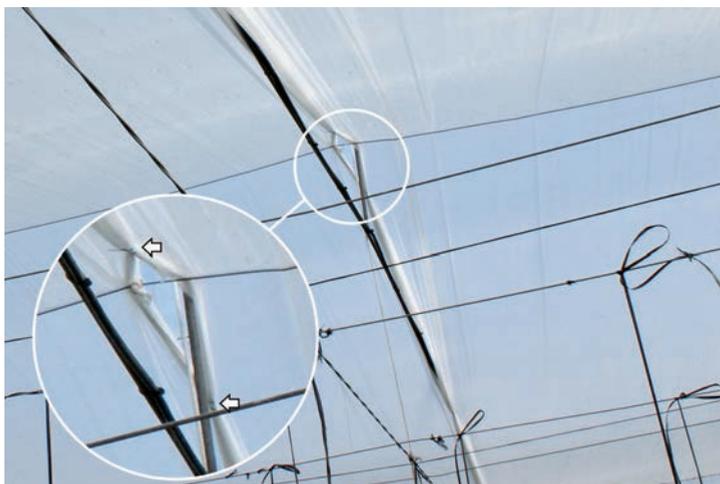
Doble techo estrecho «de poniente a levante»
